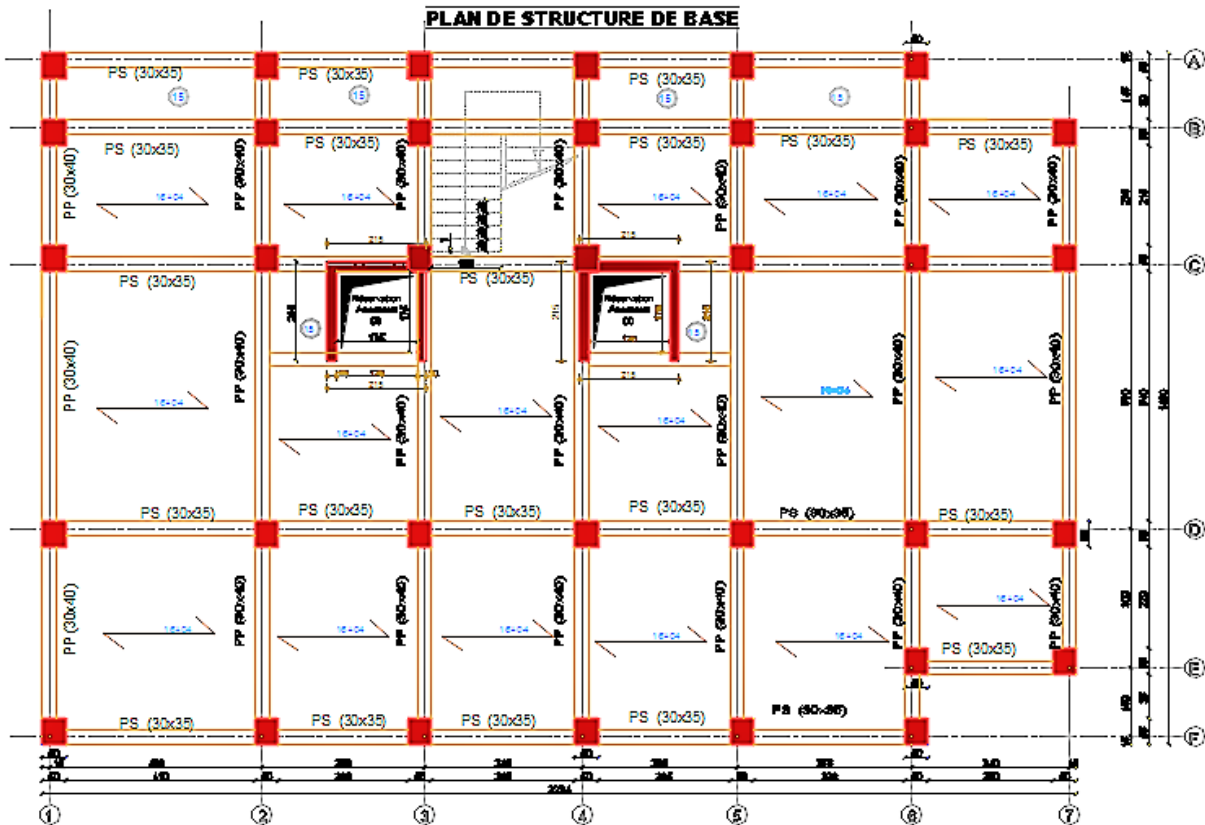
Plans de structure sur la base du pré-dimensionnement
